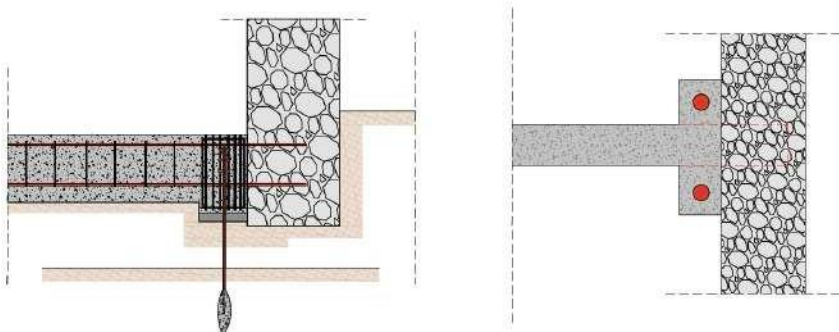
Refuerzo zapata corrida bajo muro. Tipo 4. Micropilotes. Fuente propia
